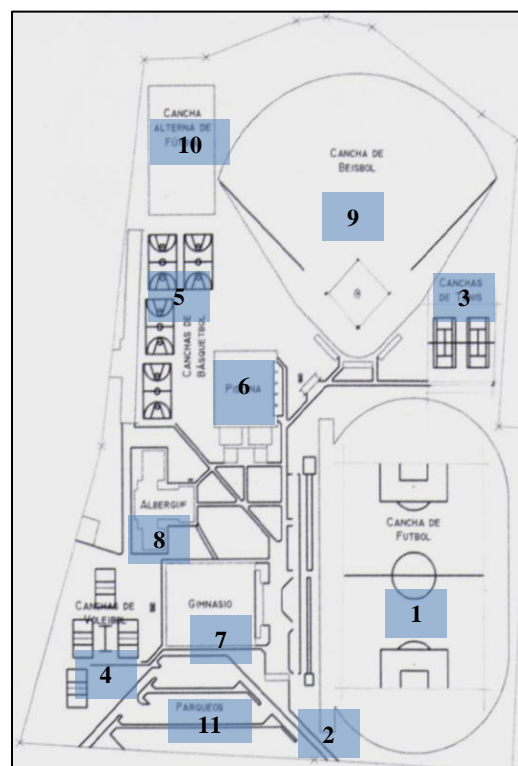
Planta del complejo Deportivo de la CDAG de Quetzaltenango
